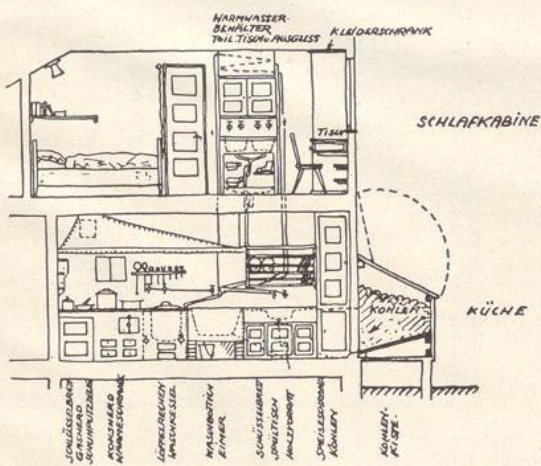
Schnitte durch das Kleinhaus. (1:100)
